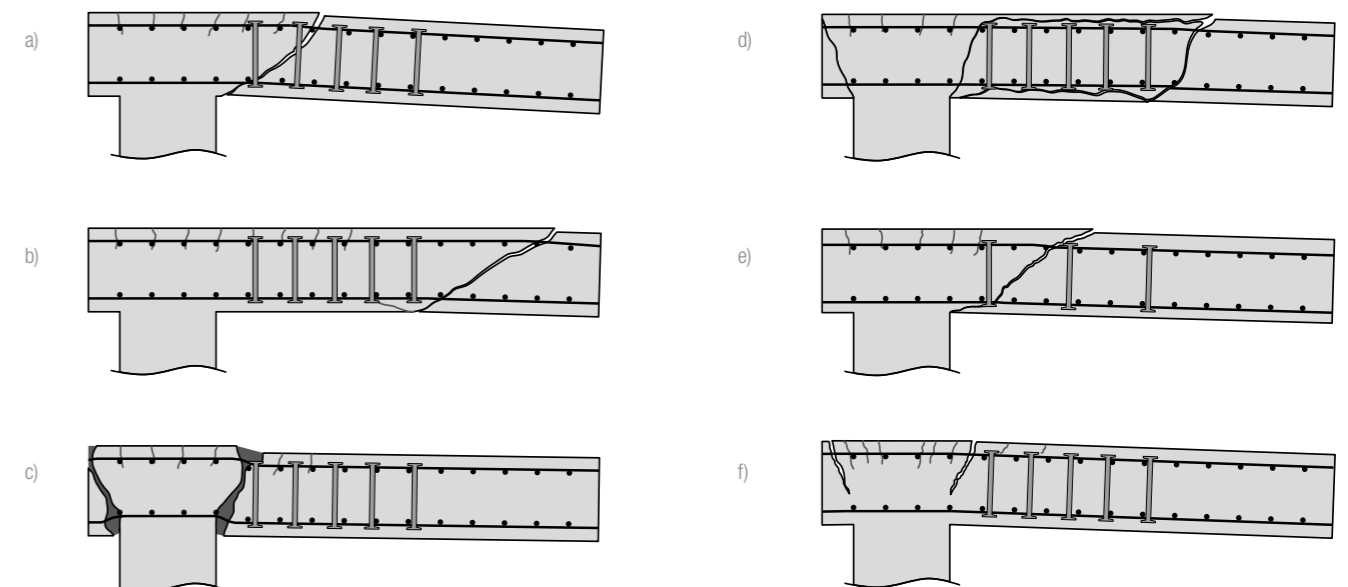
Arten des Versagens bei Durchstanzen einer Decke mit Durchstanzbewehrung
